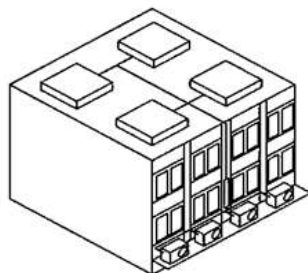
Ilustração do projeto de autoirrigação aplicado à edificação ilustrando o sistema de drenagem conectado a um reservatório discreto vertical automatizado acima dos condensadores.
